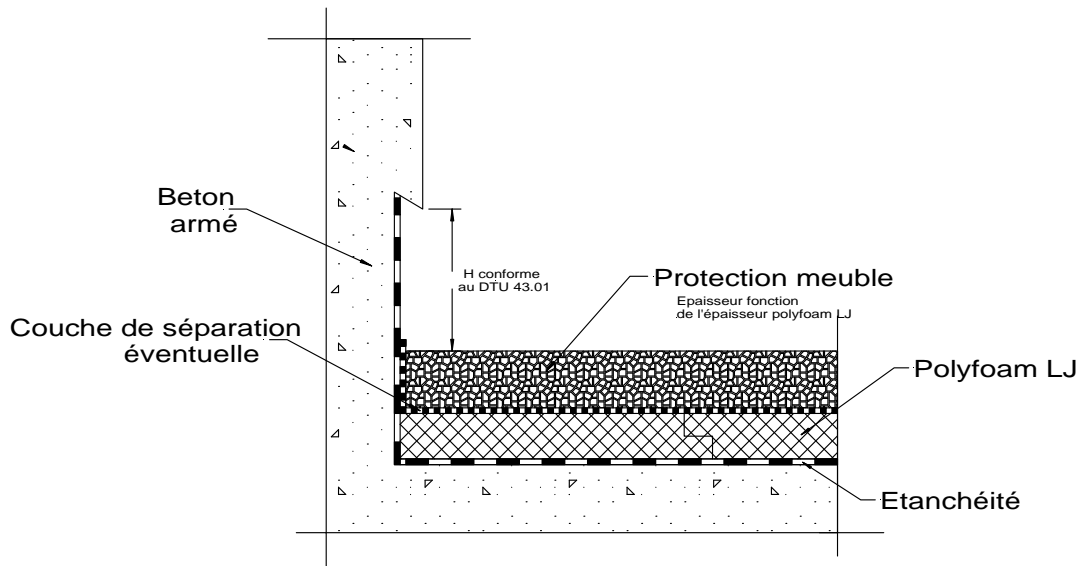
Exemple de relevé sur relief : acrotère en toiture inaccessible à retenue temporaire des eaux pluviales
